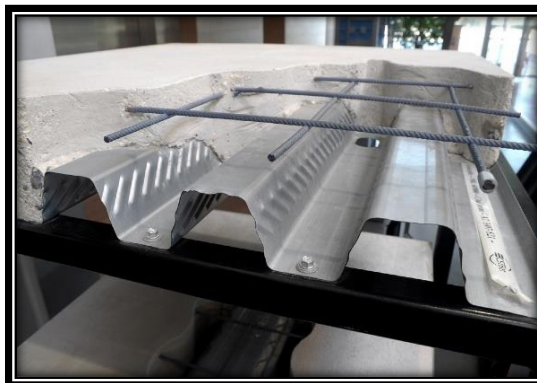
Plancher collaborant. ; Source : Save-construction. (s. d.). Save construction. Consulté le 9 juin 2021, à l'adresse <https://www.save-construction.com/user/tools/view/16>
